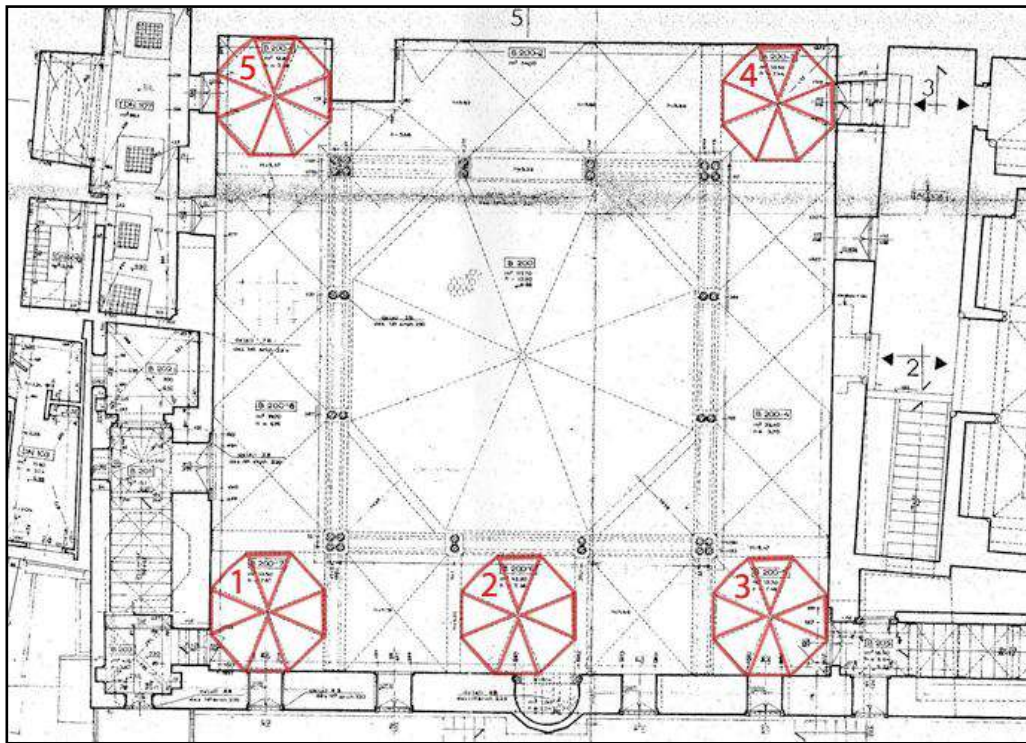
Forme des coupolettes, mosquée du Dey.
